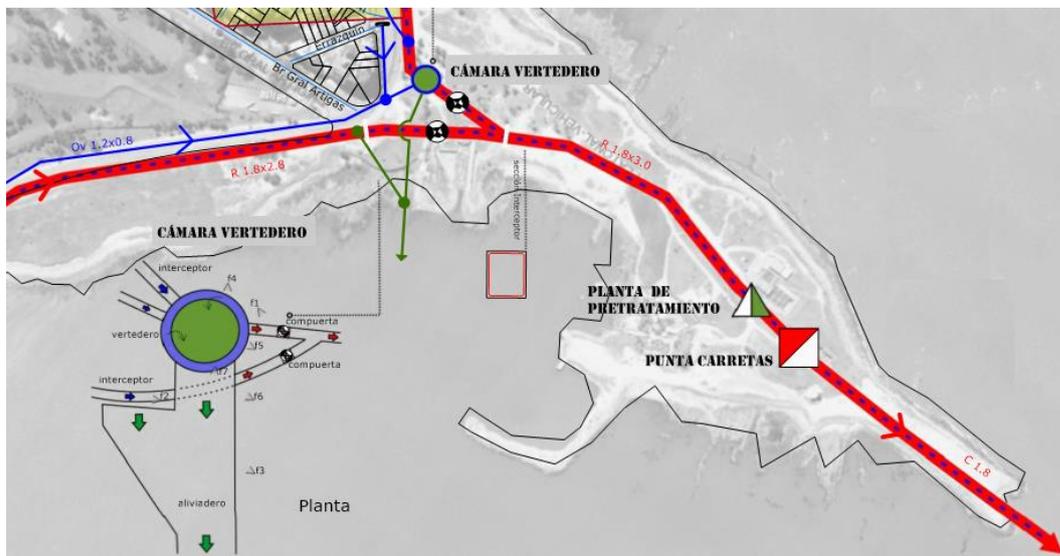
Planta de Pretratamiento de Punta Carretas (IM - SIG SF)
